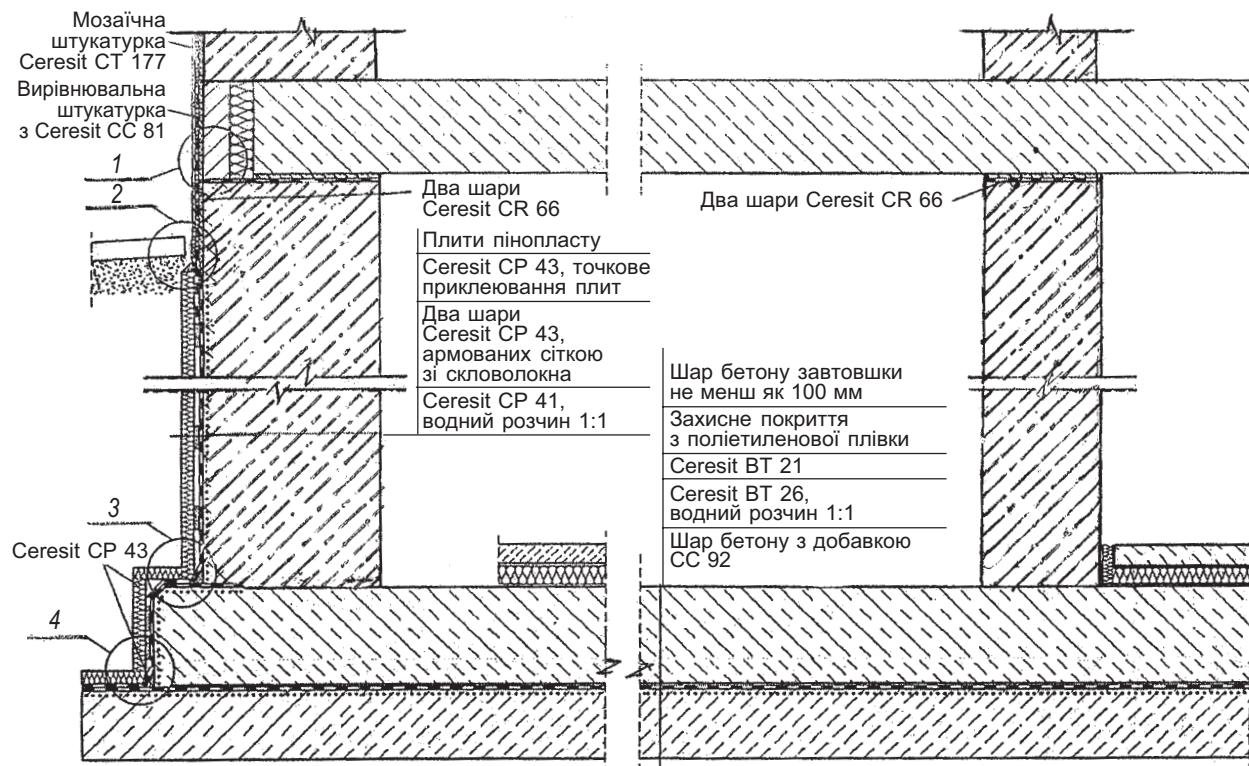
Ізоляція фундаменту та стін підвалу від ґрунтових вод
